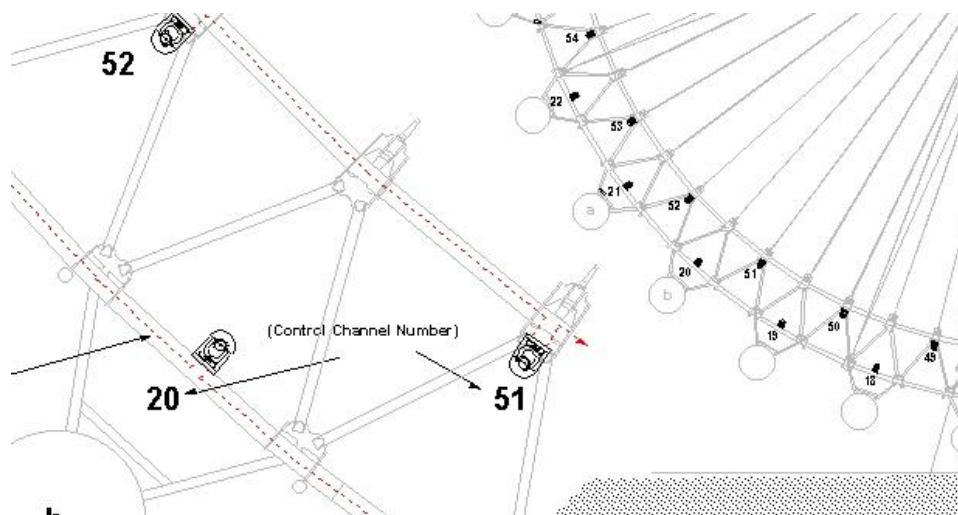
Particolare costruttivo dell'ancoraggio dei cavi radiali, London Eye, 2000.
